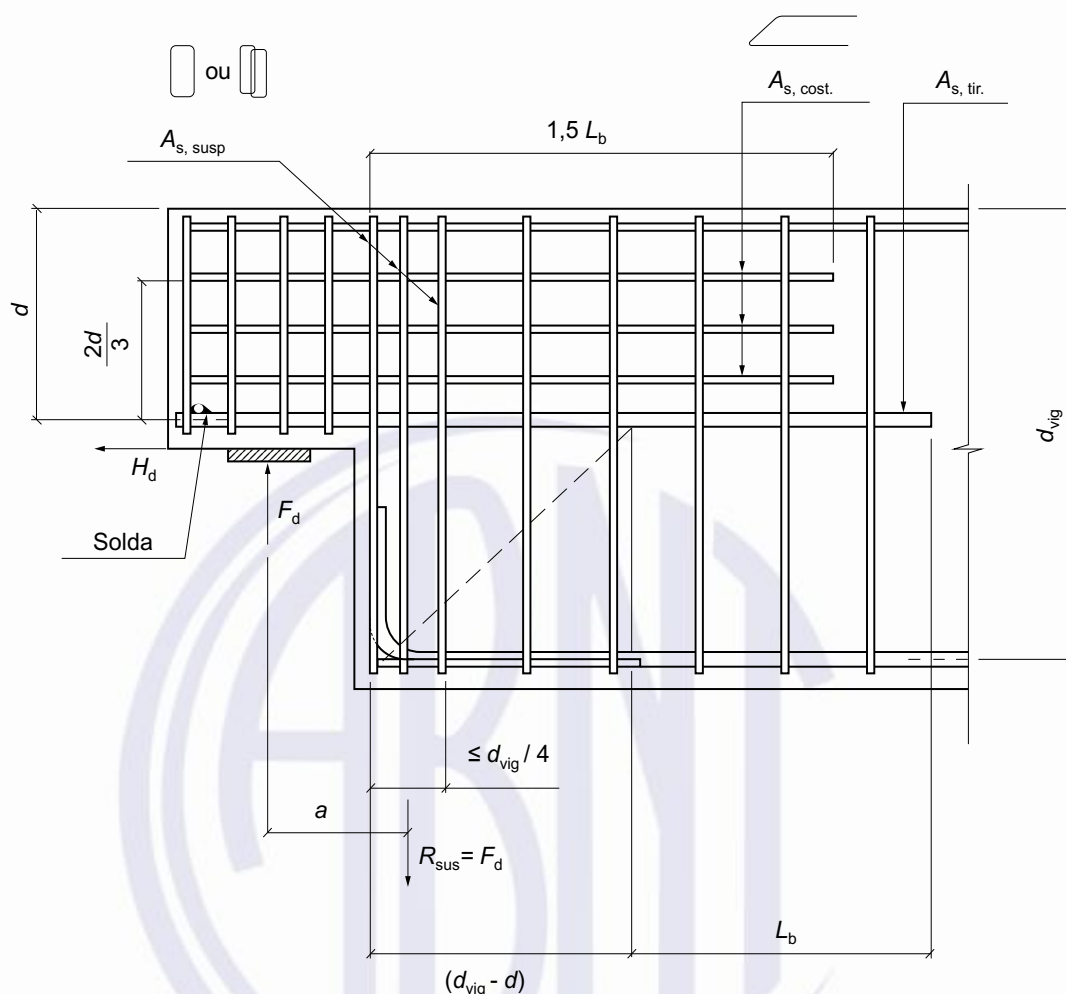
Detalhe de armadura em consolo tipo Gerber
